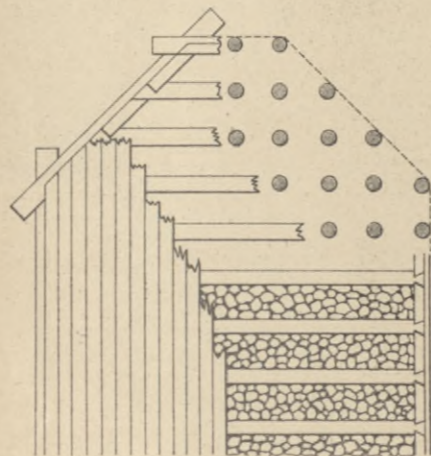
u. 19. Rost für ein schiefes Widerlager. Fig. 18. Querschnitt. A cross-sectional diagram of a pile wall for an inclined abutment.
